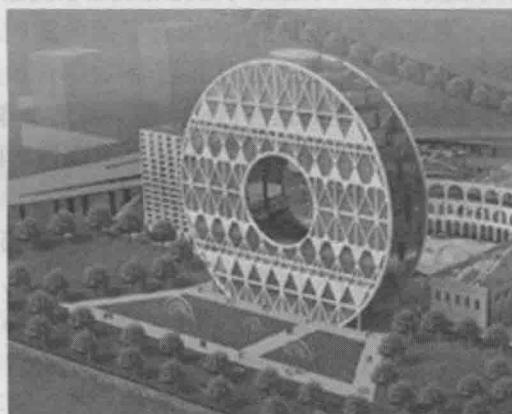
钢支撑框架+钢筋混凝土核心筒混合结构（广东兴业国际大楼）
